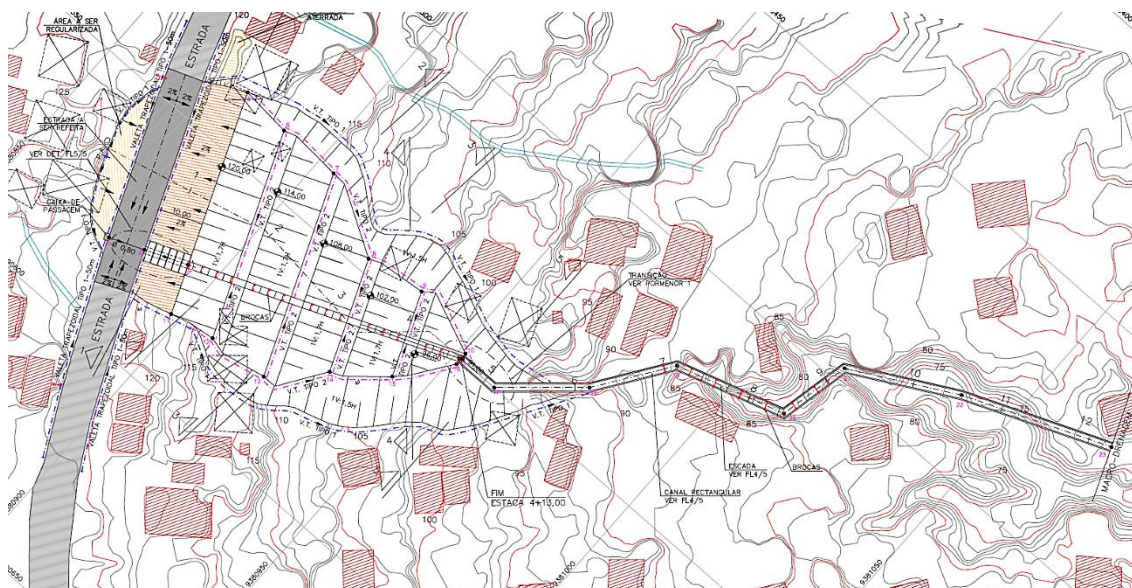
Planta geral com taludes, banquetas e dispositivos de drenagem, projeto de execução (BDM, 2017)
